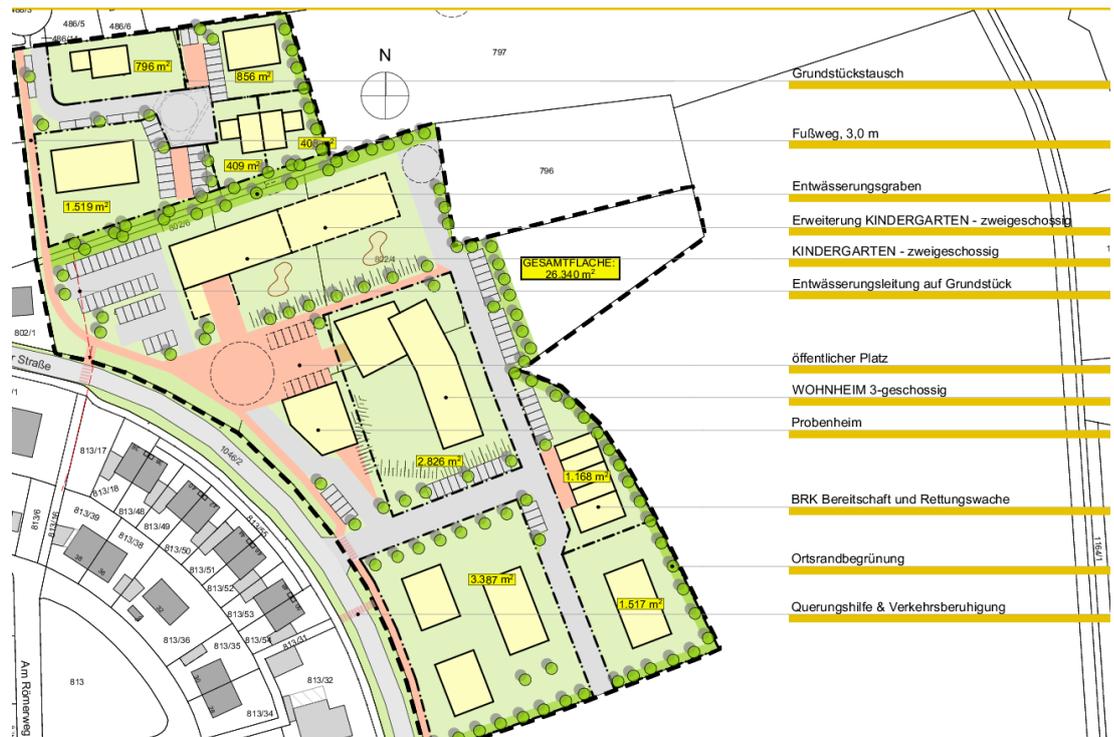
Ausschnitt aus der Masterplanung Isen – Haager Straße, Planungsgruppe Winkler-Ackermann Ingenieure & Architekt Partnerschaft, 02.12.2019, ohne Maßstab
